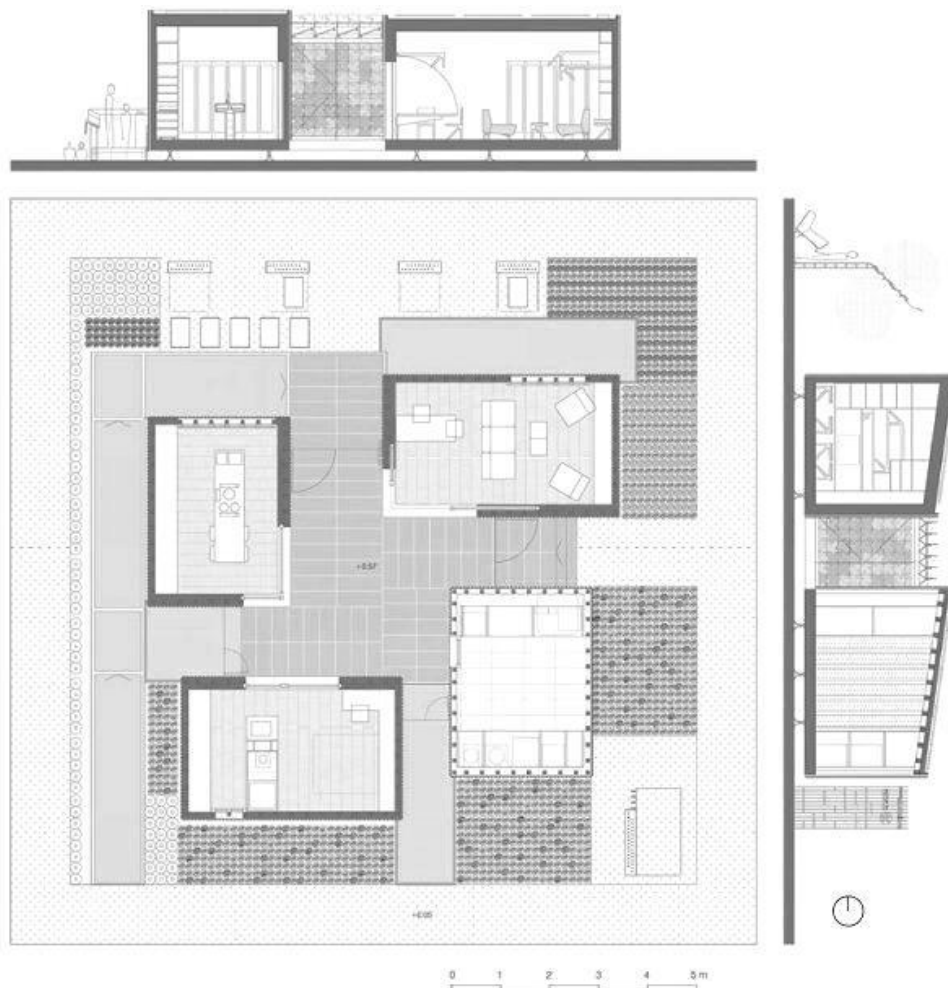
Planta del proyecto: Casa SMLSYSTEM.
